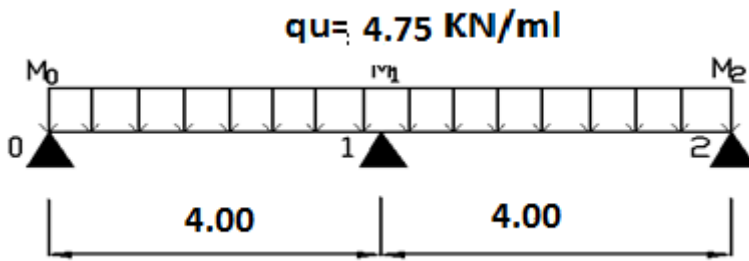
schéma statique de la poutrelle type 1 à l'ELS
